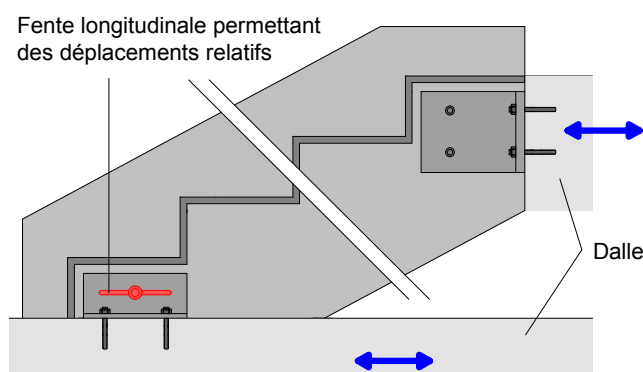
> Mesures applicables aux volées d'escaliers
